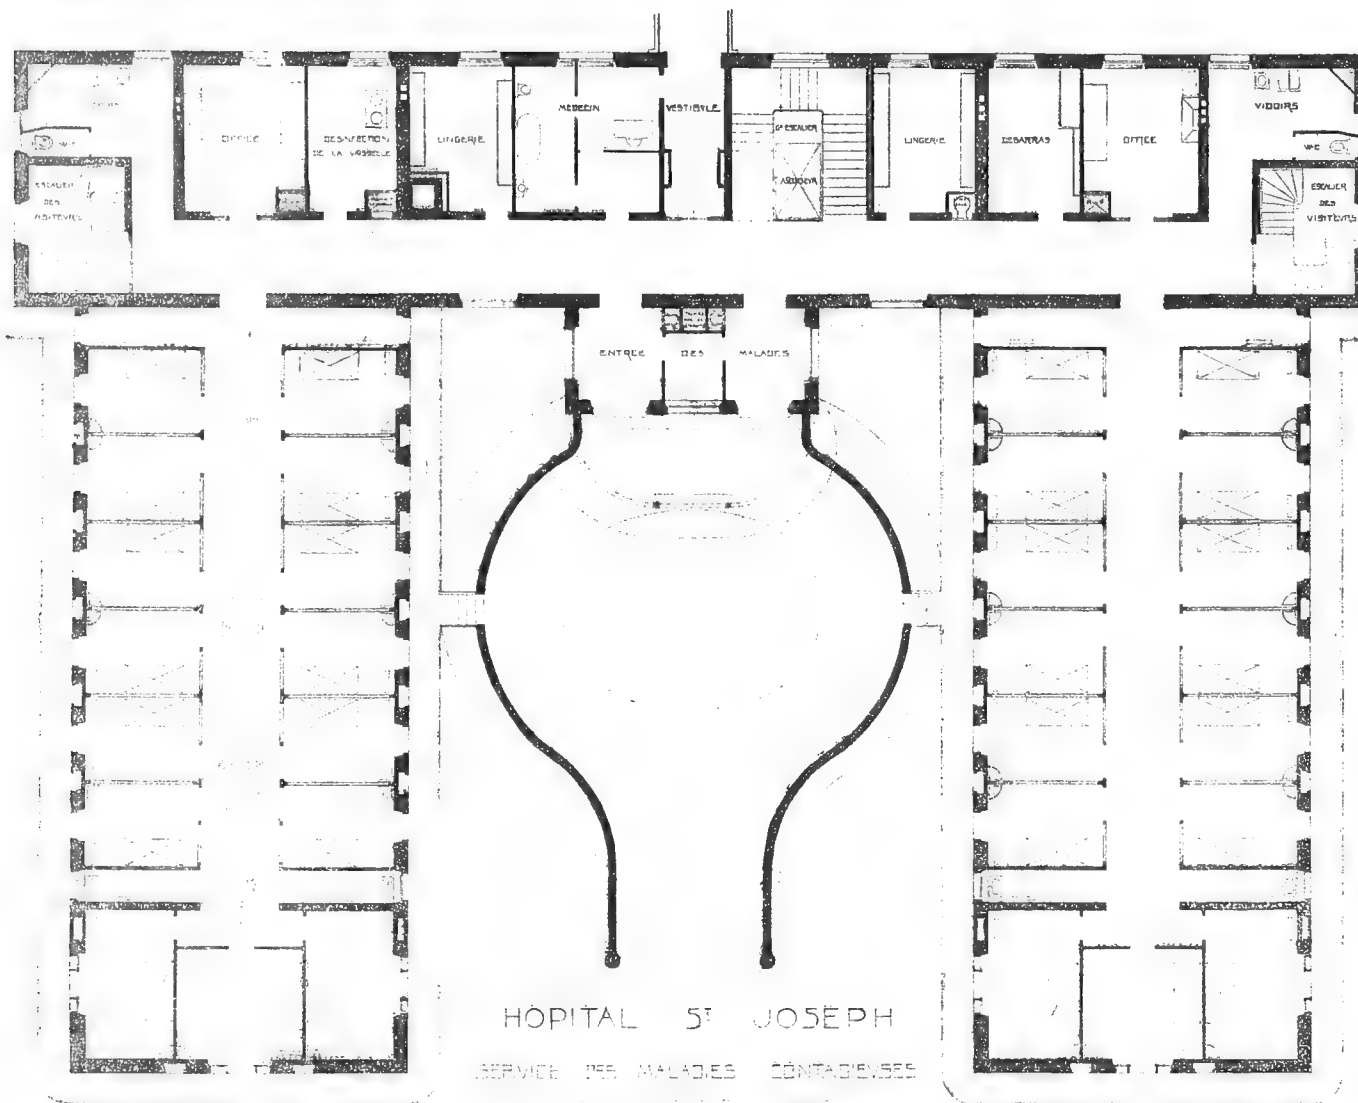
Plan du pavillon des contagieux. Rez-de-chaussée.
